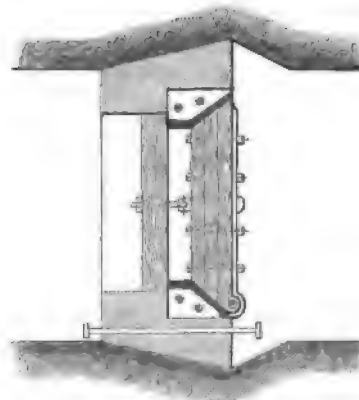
Hölzerne Dammtür mit gußeisernem Rahmen (Grundriß).
